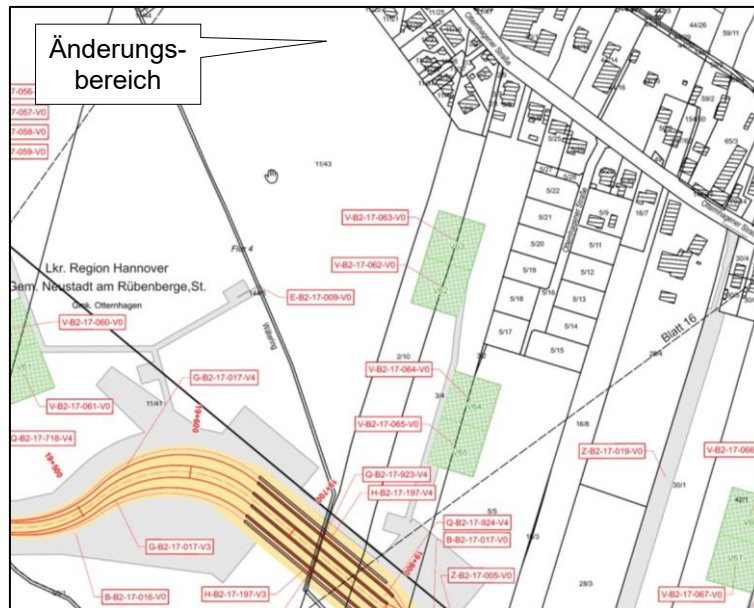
Änderungsbereich auf einem Ausschnitt aus den Planfeststellungsunterlagen des SuedLink (B2_C_06_Lageplan_An101_B115_R01-gez.pdf, unmaßstäblich, nicht geordnet)
